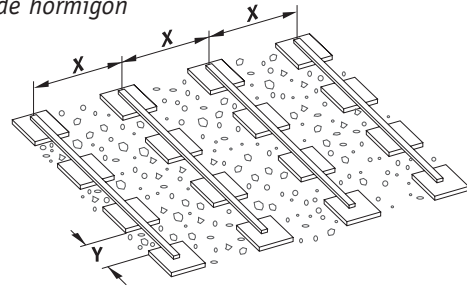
Colocación con rasteles de subconstrucción sobre suelos de hormigón
